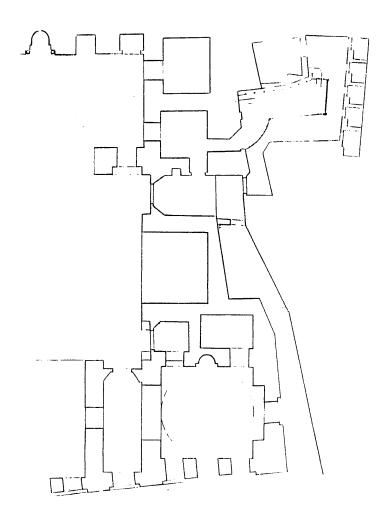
مسقط أفقى لمدرسة وقبة السلطان حسن عن فراترباشا
